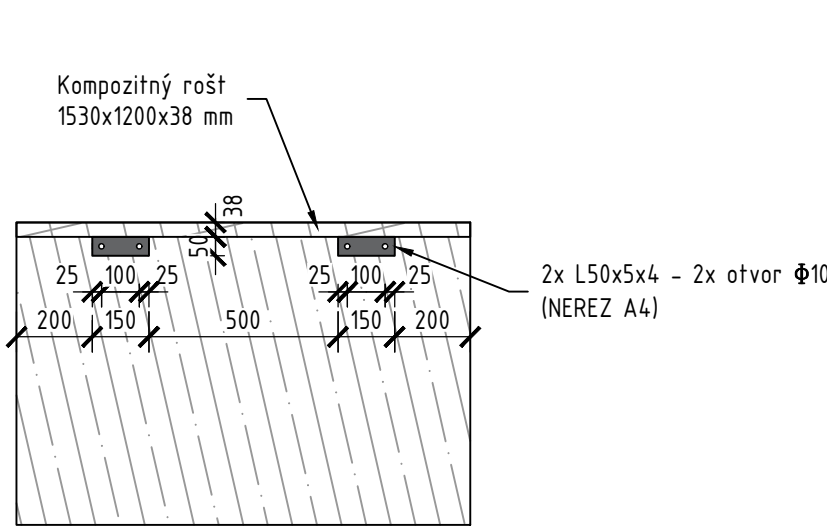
DETAIL OSADENIA KOMPOZITNÉHO ROŠTU
